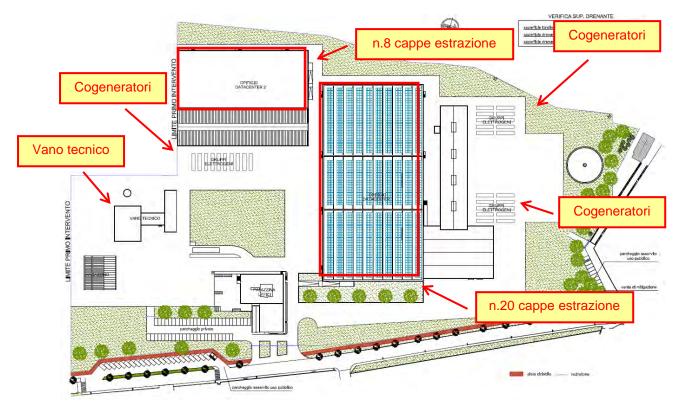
Stralcio planimetrico progetto Aruba con indicazione degli impianto individuati.
